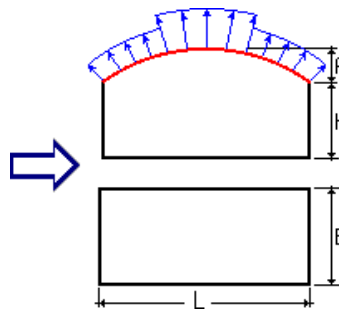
Схема будівлі з напрямком вітрового впливу
